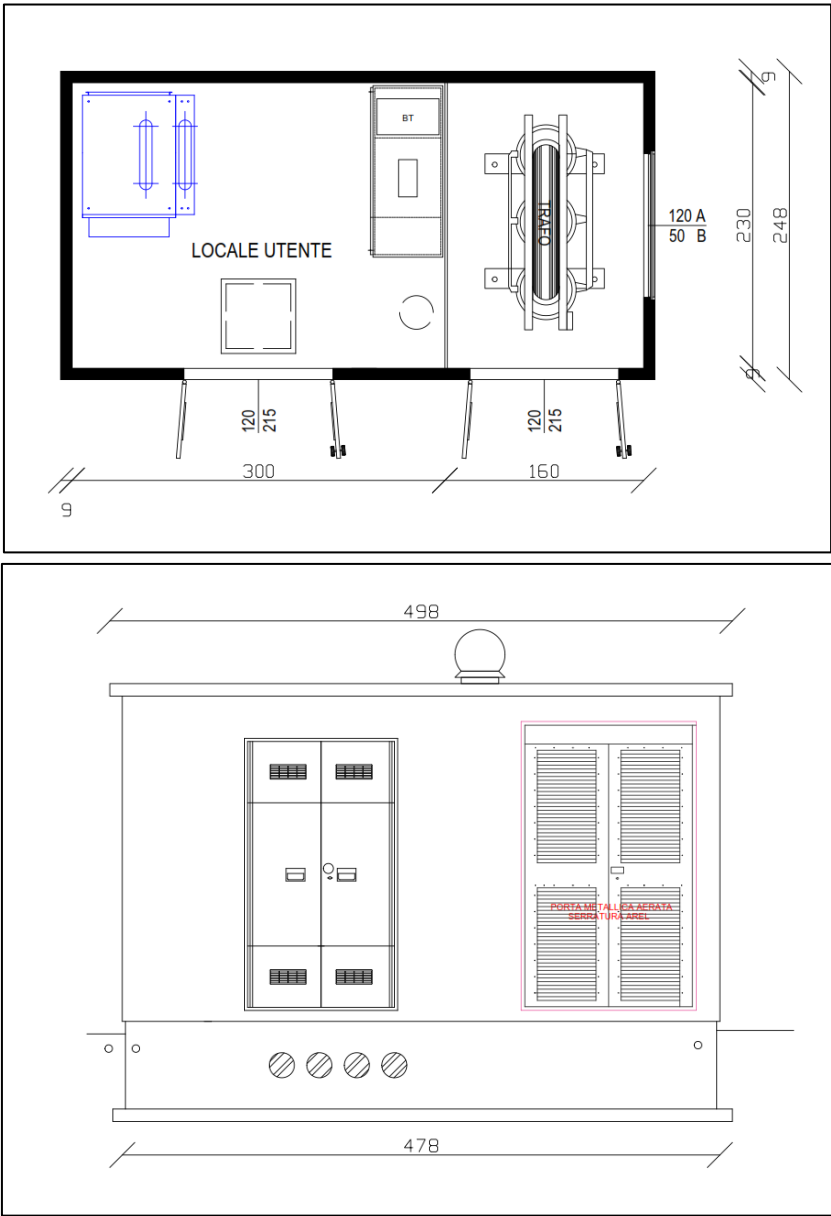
Planimetria e prospetto tipo cabina di trasformazione.
